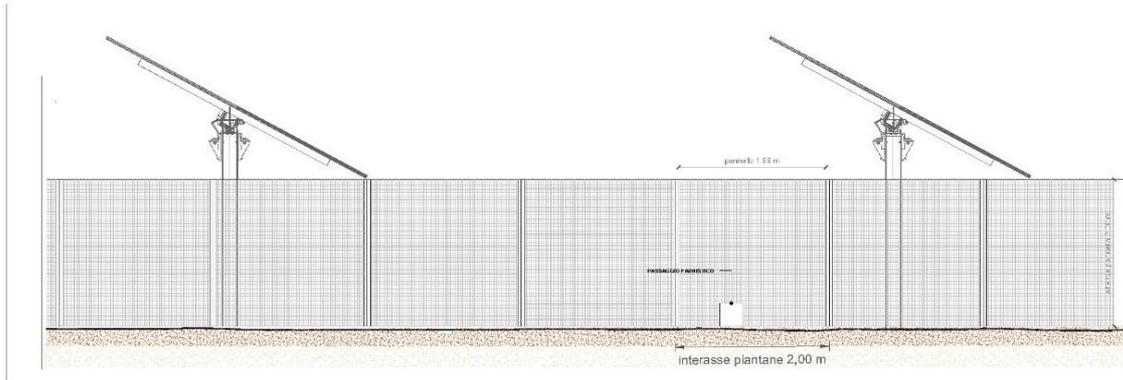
Prospetto recinzione perimetrale senza mitigazione
